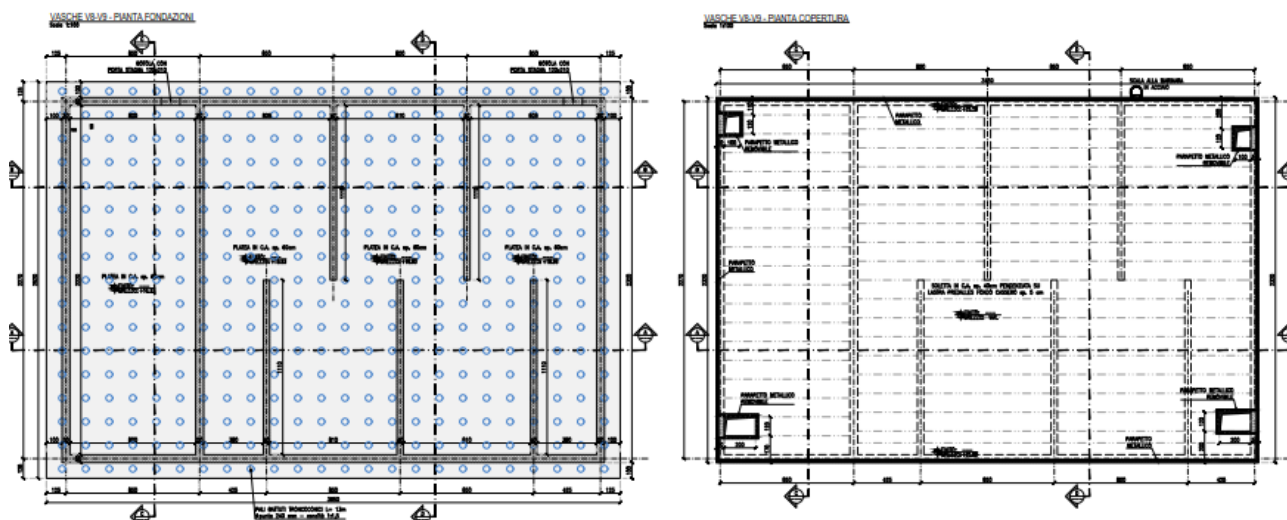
Pianta fondazioni Vasche V8-V9
